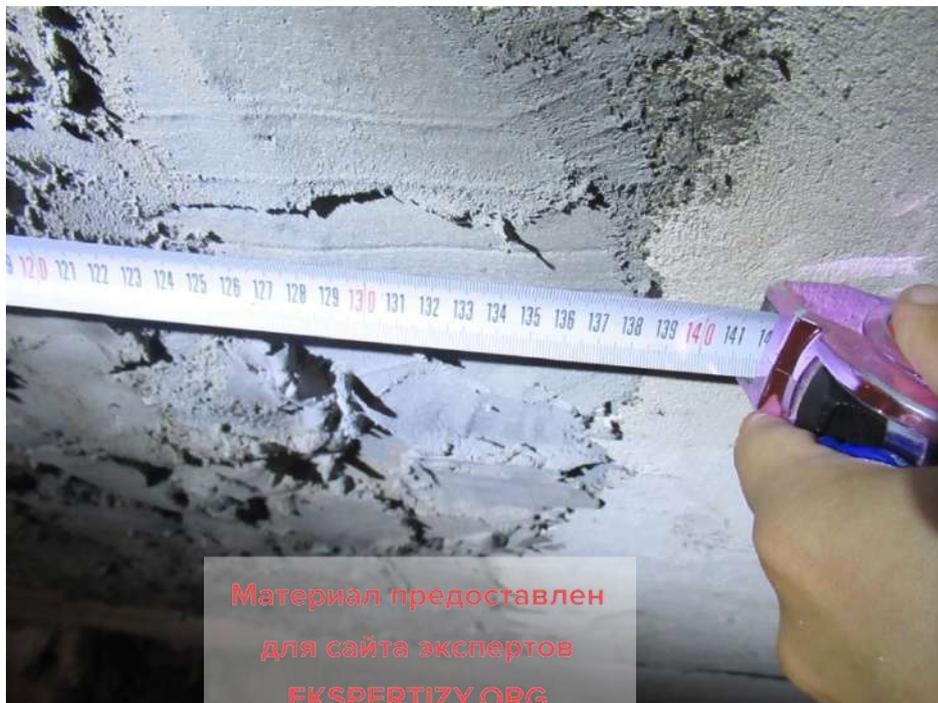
Контрольные замеры зоны производства работ по усилению перекрытия подвала на первом участке ремонтируемого перекрытия.
